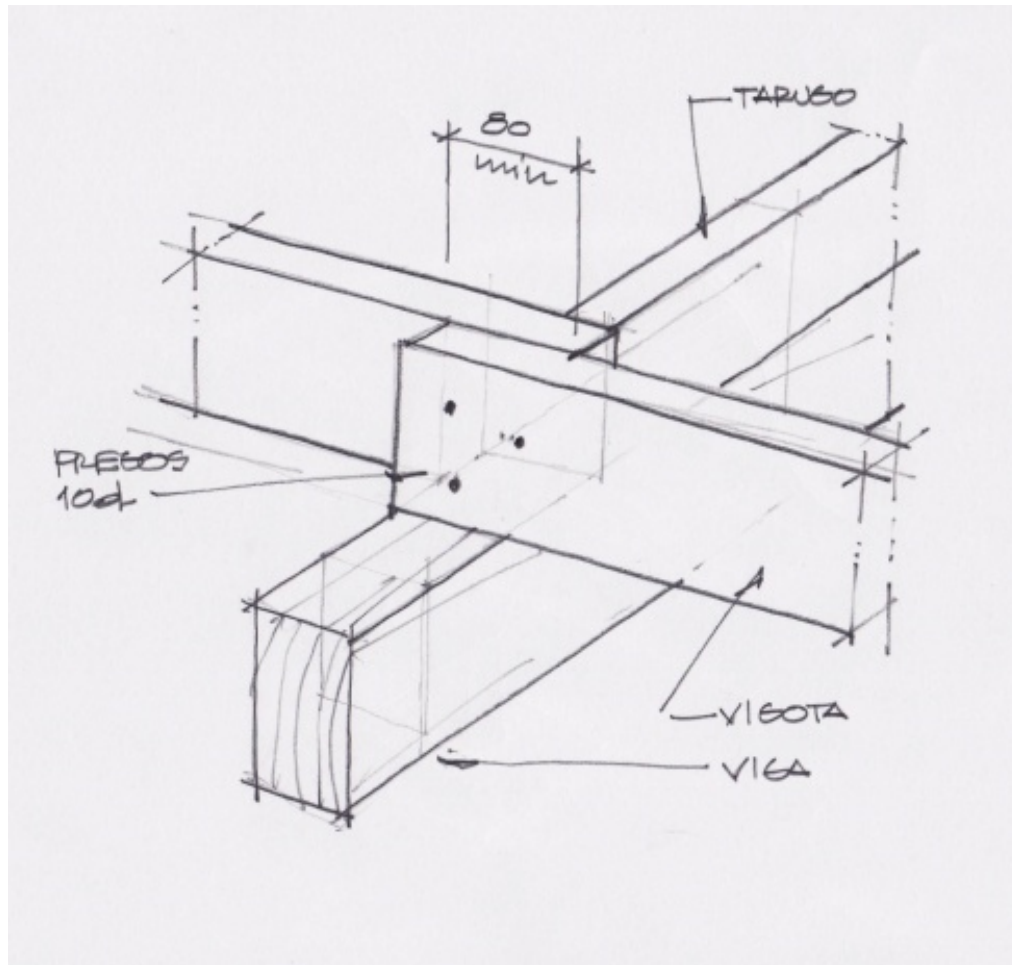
Apoio e pregagem de vigotas de pavimento me apoio intermédio do pavimento. (des. autor)
